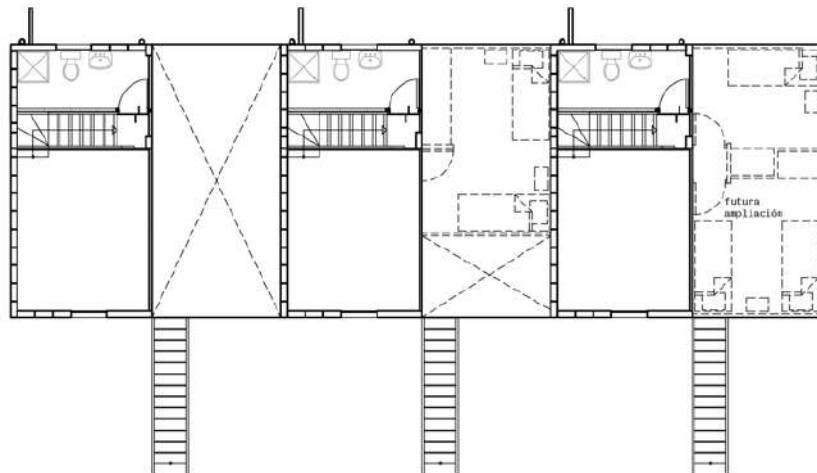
Planta Baixa do Pavimento Térreo da edificação do Conjunto Quinta Monroy
